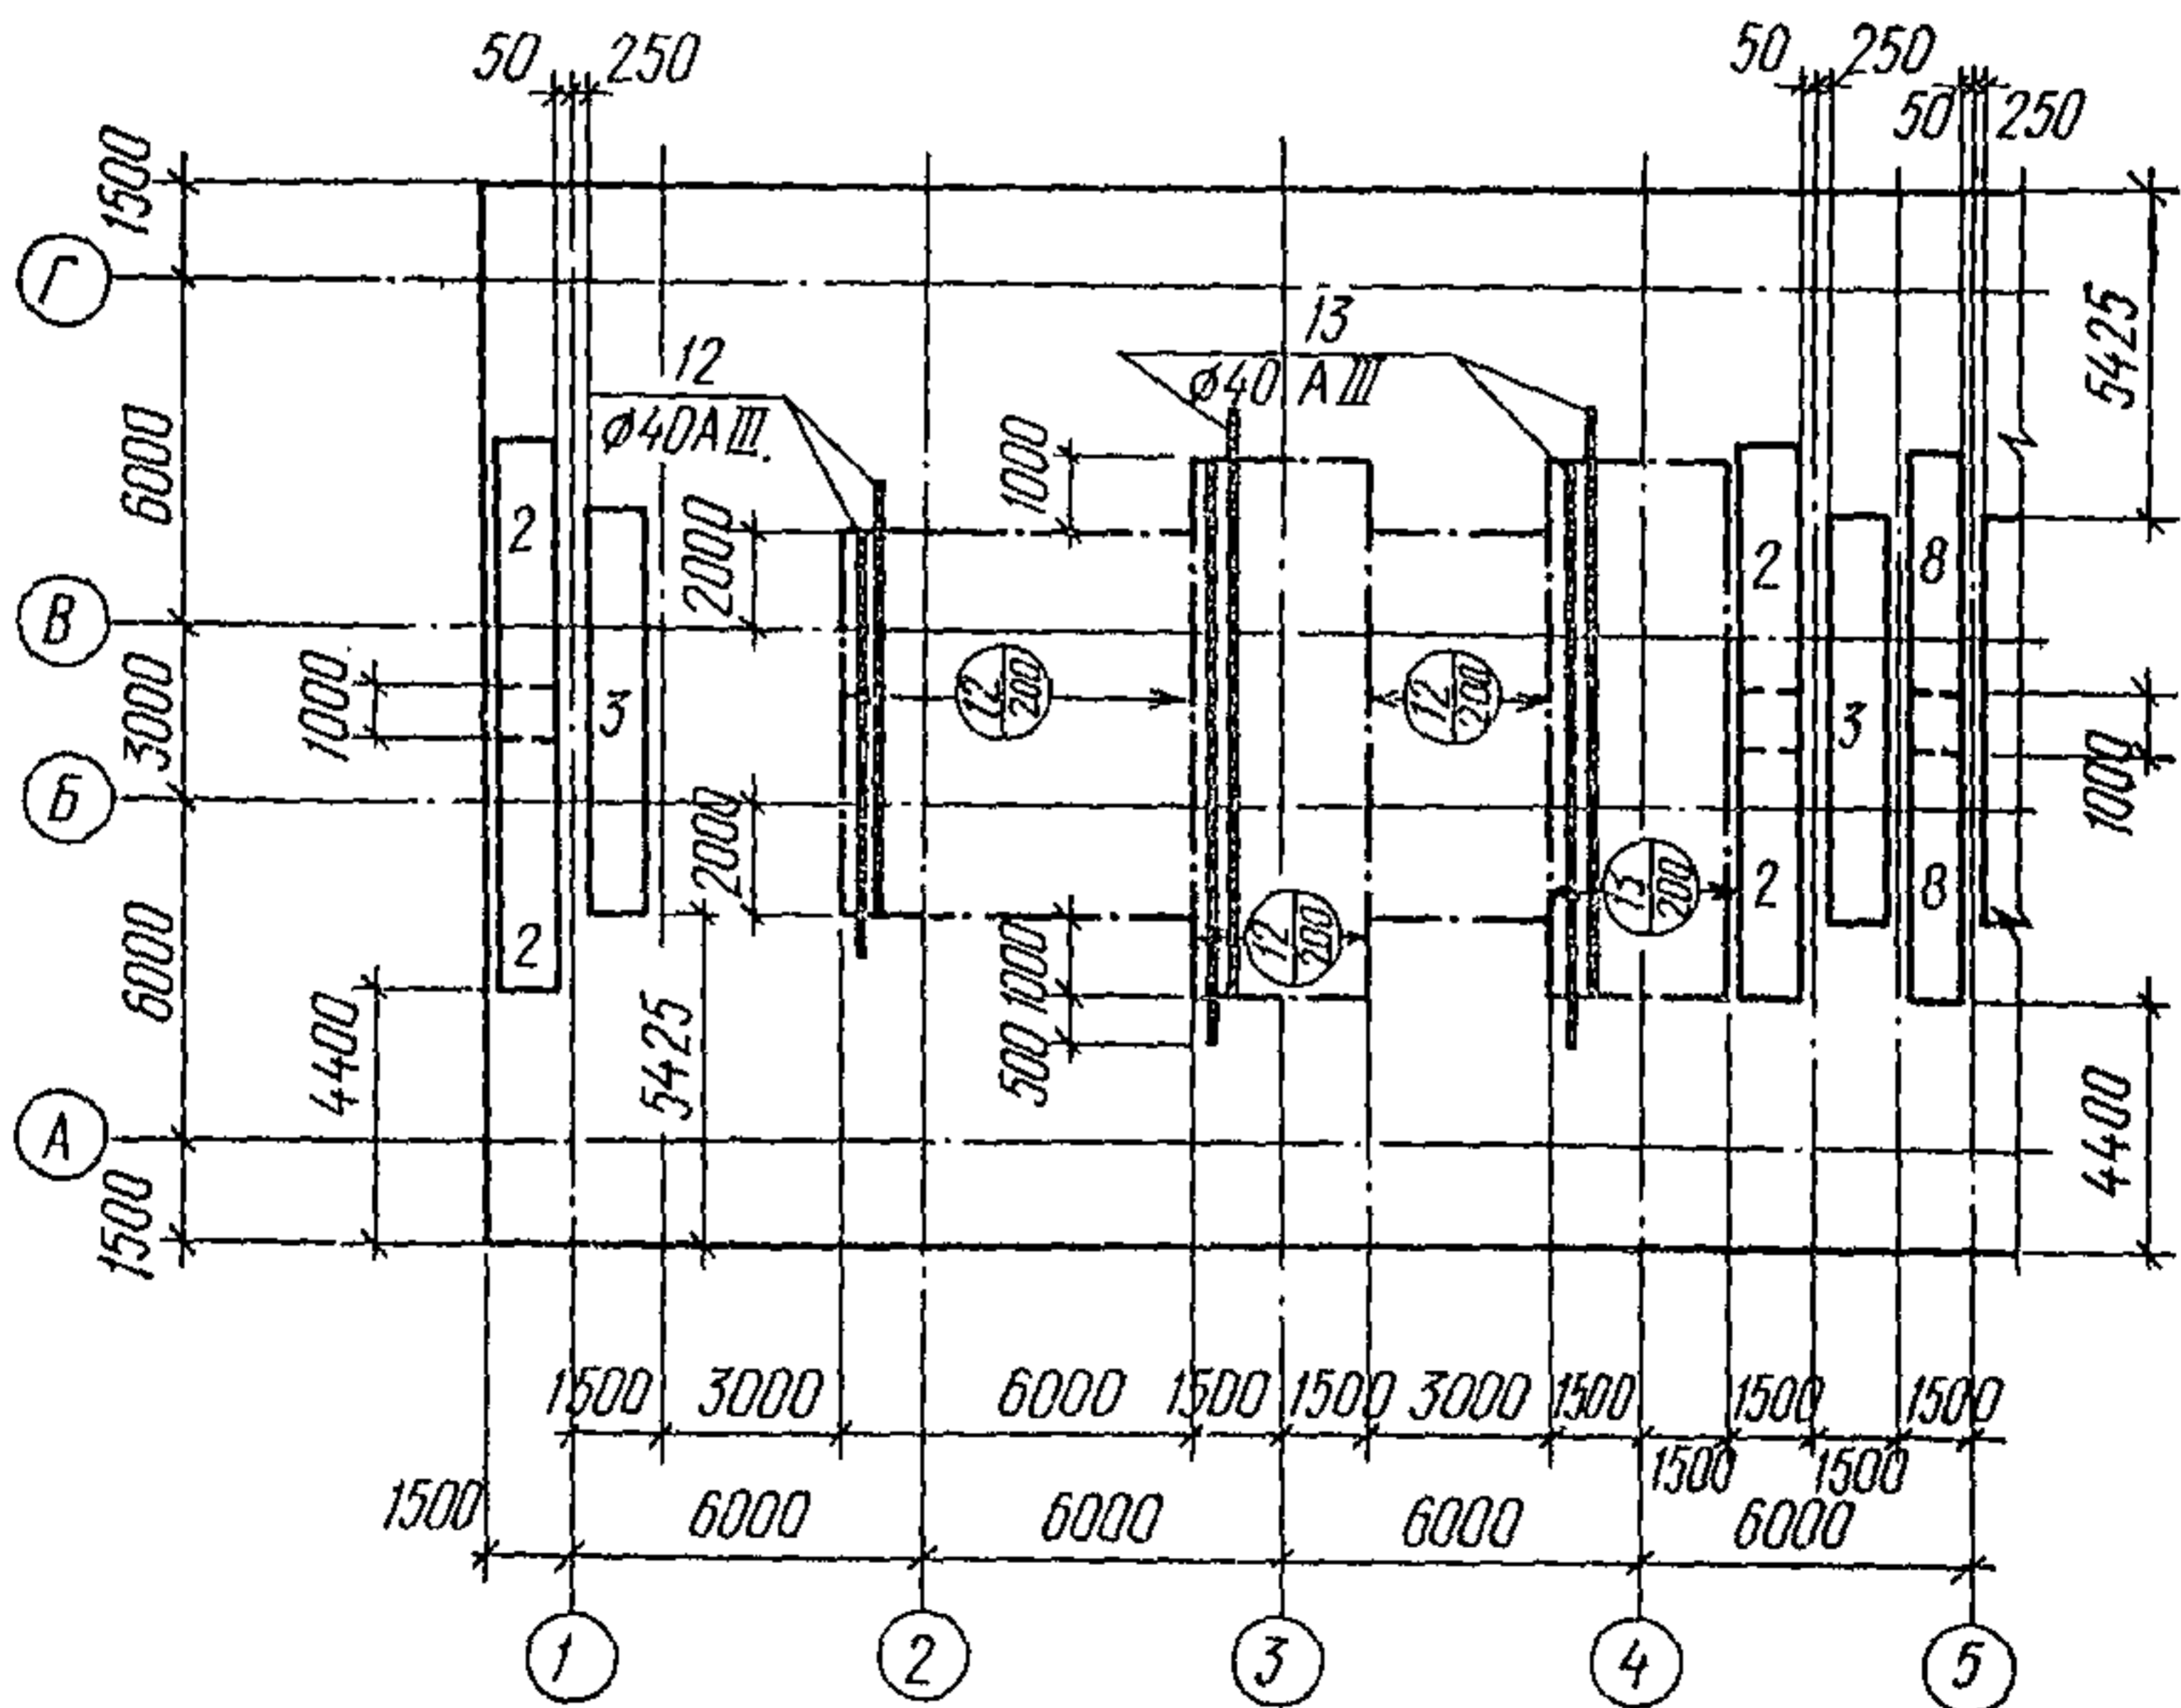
План раскладки в поперечном направлении плиты унифицированных сеток третьего слоя нижней зоны
